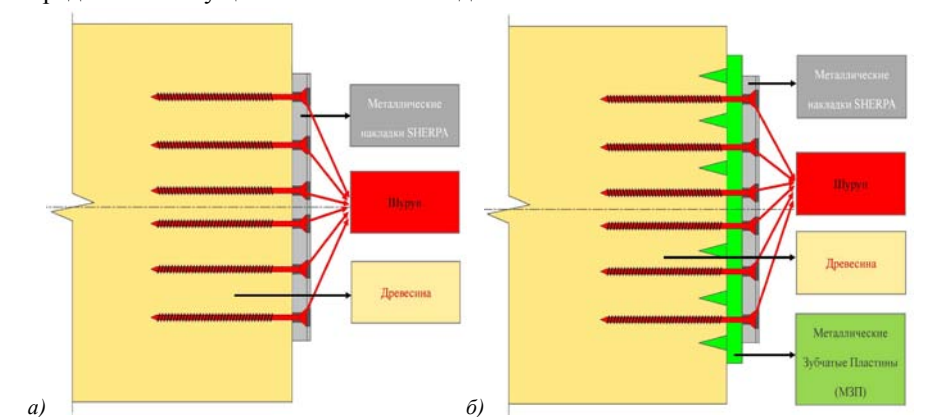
Конструктивная схема соединения деревянных элементов на металлической накладке и шурупов: а – без укрепления МЗП; б – с укреплением МЗП
